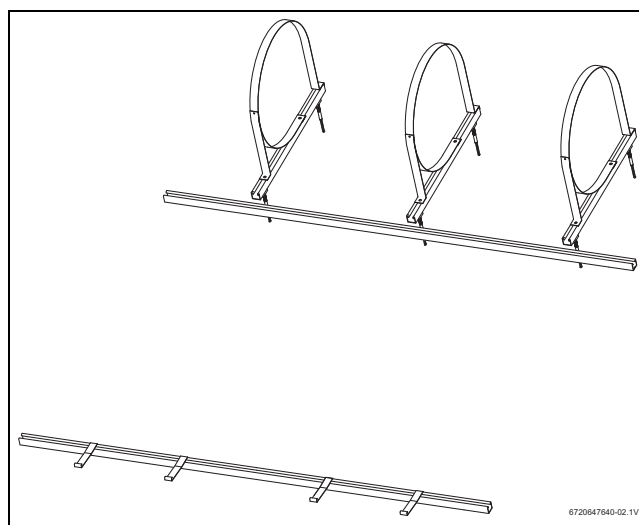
Vista de conjunto del soporte para tejado inclinado (sistema de 300 l)
